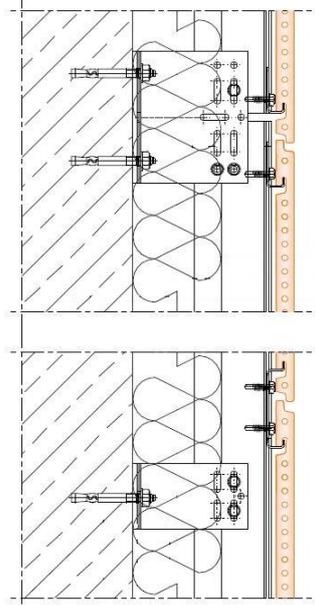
Sección vertical. FAVEKER® FV. Sistema clip.
